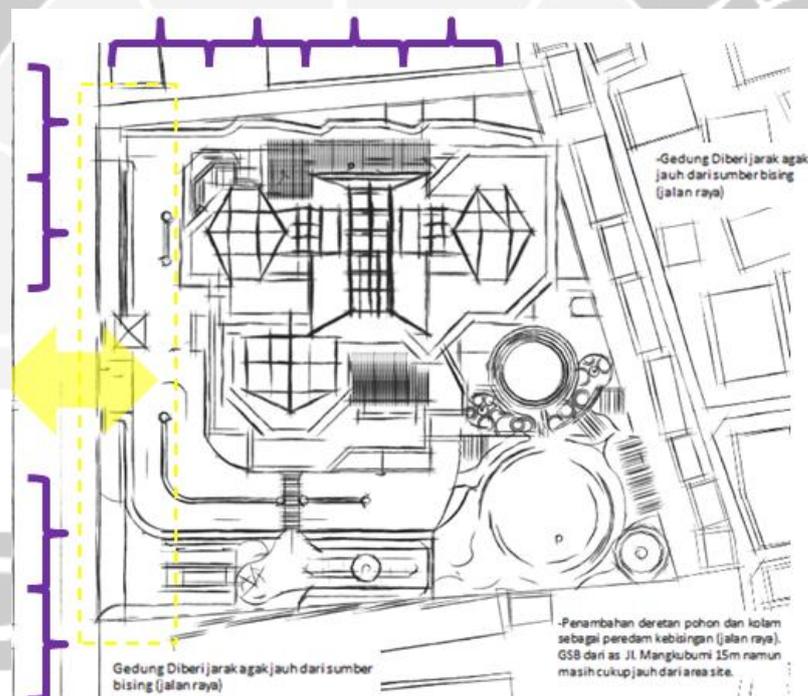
Konsep Sirkulasi dalam Site Plan
